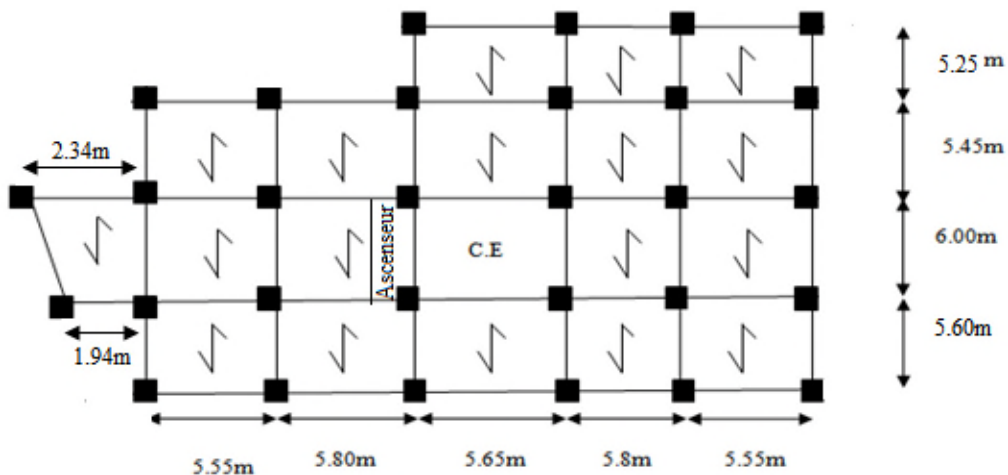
Disposition des Poutrelle du 3^{ème} au 10^{ème} étage
